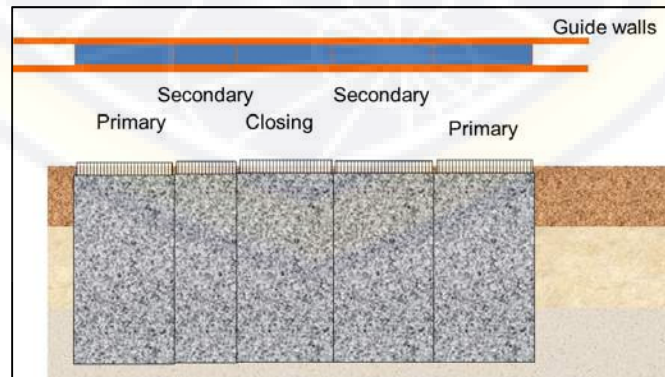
Sketsa Pemasangan Joint dan Erection (Reinforcement)
